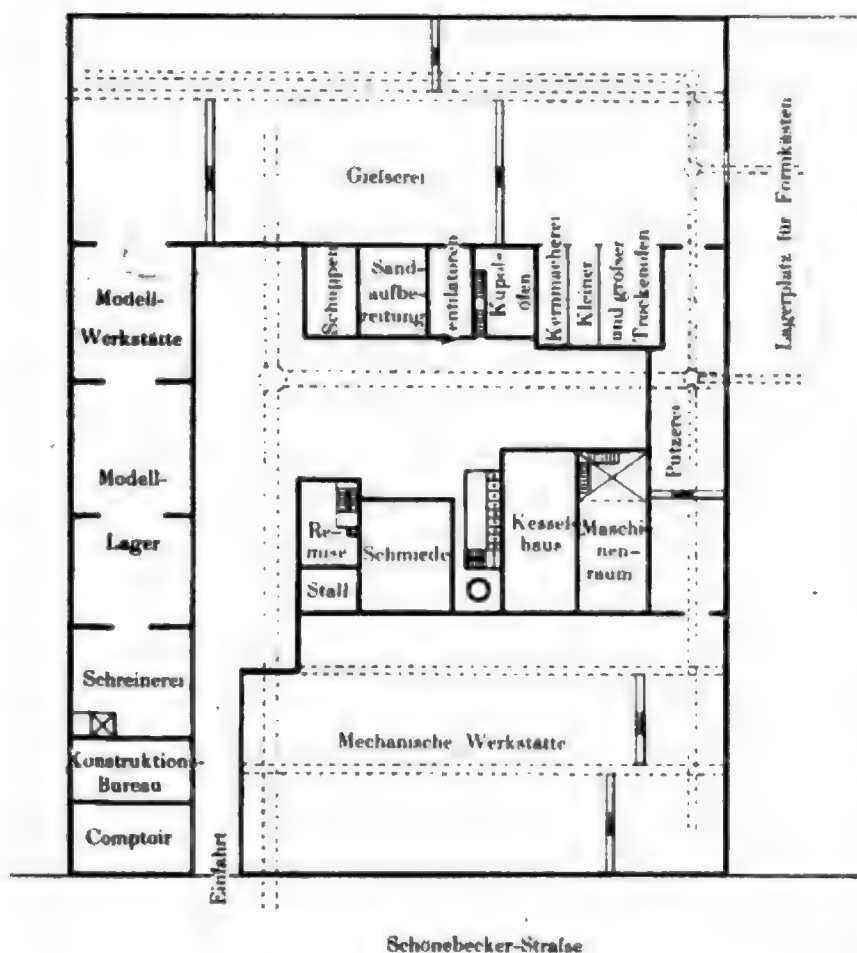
Lageplan der Wupperthaler Eisenhütte.
